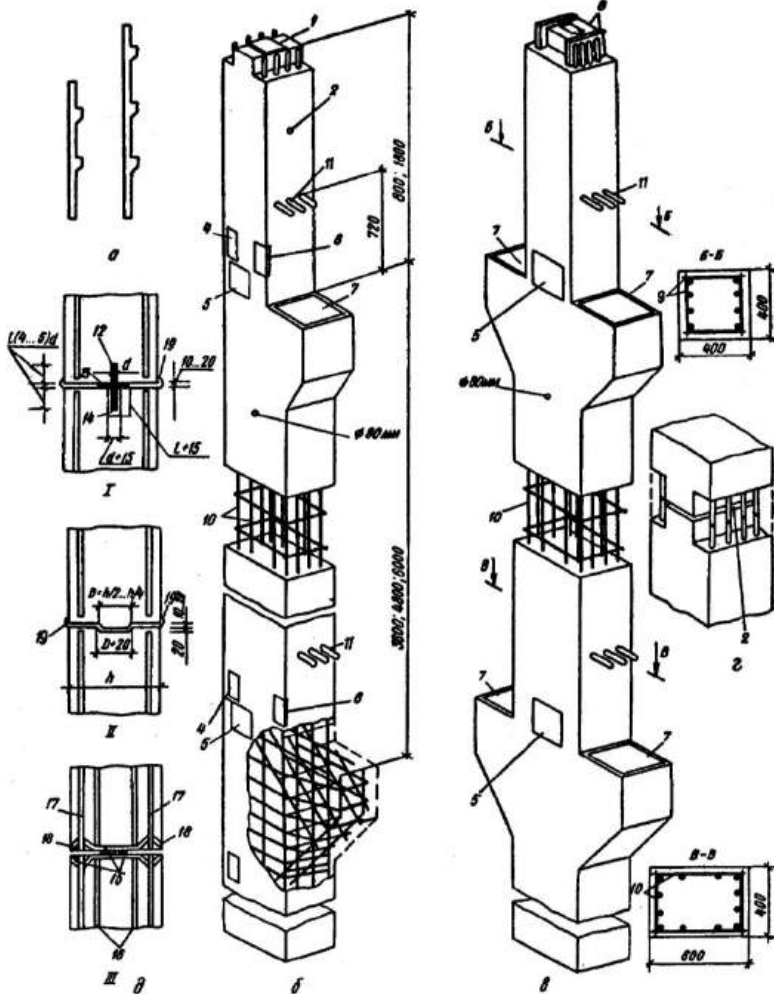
Збірні колони з консолями багатопверхових каркасних будівель: *a* – загальний вигляд колон на два і три поверхи; *б* – крайня; *в* – середня колона; *г* – стик колон зі зварюванням арматурних випусків; *д* – контактні стики колон; *I* – стик з центруючим штирем; *II* – стик з виступом верхньої колони і гніздом у нижній; *III* – стик зі сталевими пластинами на торцях колон; *I...7* – закладні деталі; *8* – металева обойма; *9* та *10* – просторові арматурні каркаси; *11* – арматурні випуски для стиків із ригелями; *12* – штир; *13* – центрувальна прокладка; *14* – гніздо; *15* – сталеві пластинки; *16* – арматурні стержні; *17* – стержні, які пропускають крізь отвори в пластинках і зварюють із ними; *18* – зварні шви; *19* – заповнений розчином зазор
